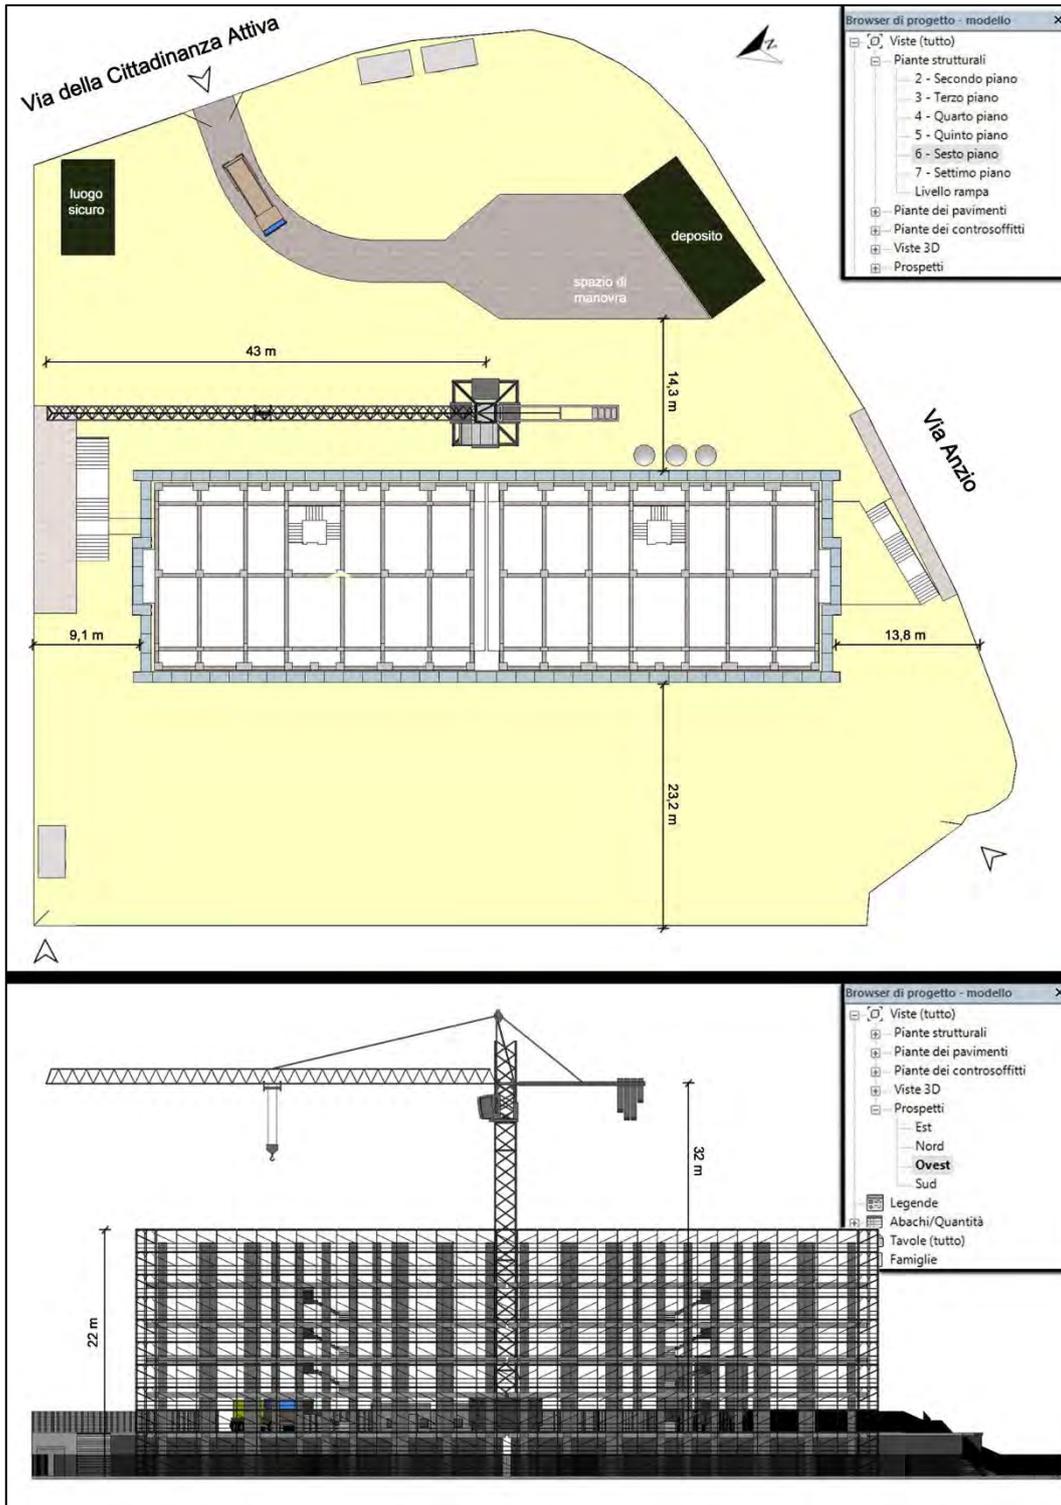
Planimetria e prospetto della fase di realizzazione dei pilastri dell'ultimo livello
